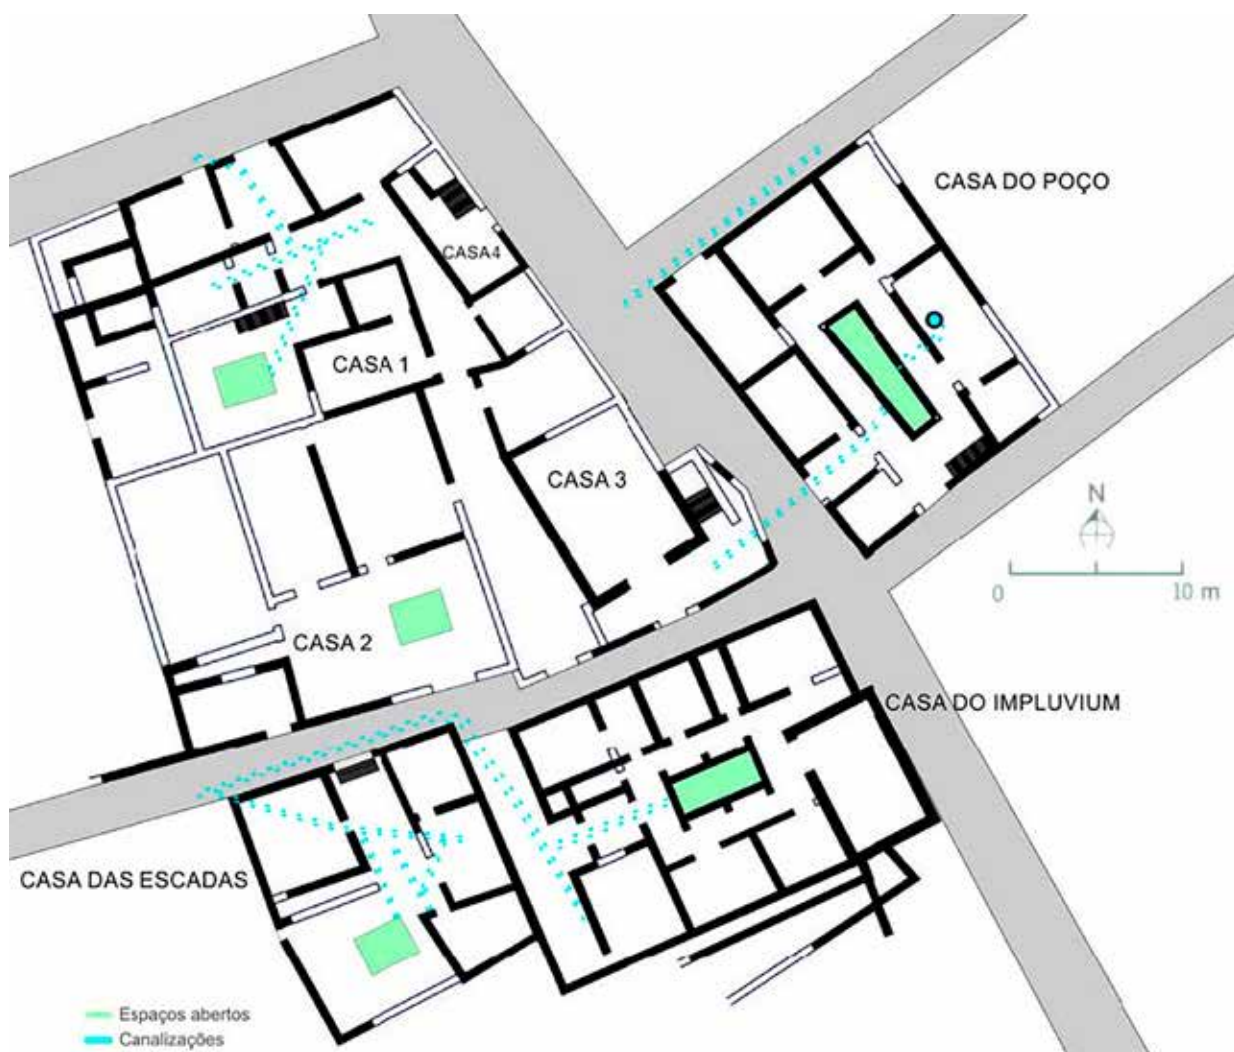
Planta del barrio doméstico altoimperial de Tongobriga (Magalhães et al., 2022: 490, fig. 2).
